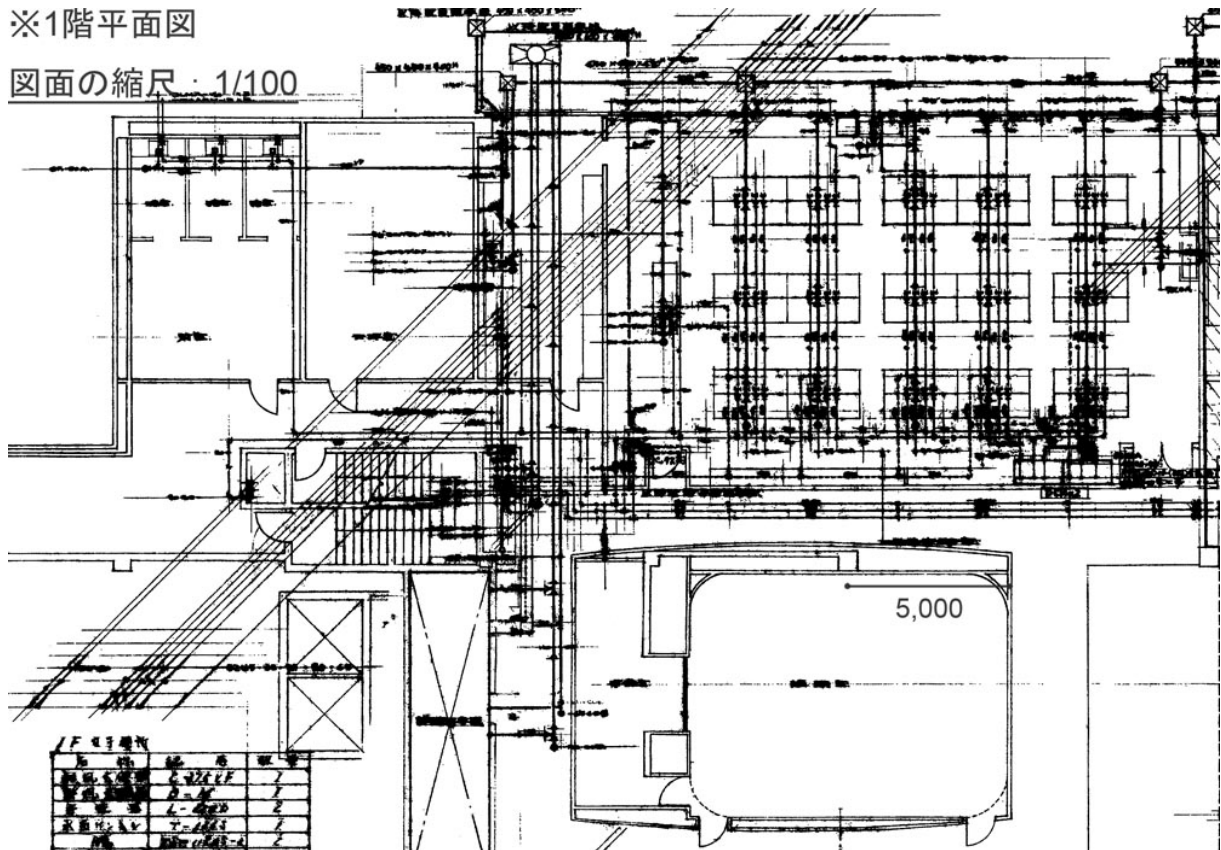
衛生の平面図の一部を抜粋 (資料 C)
